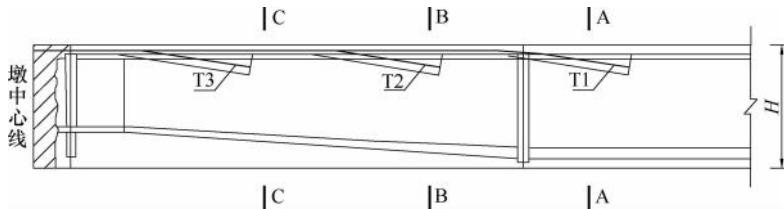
连续体系负弯矩钢束锚固齿块布置立面图
